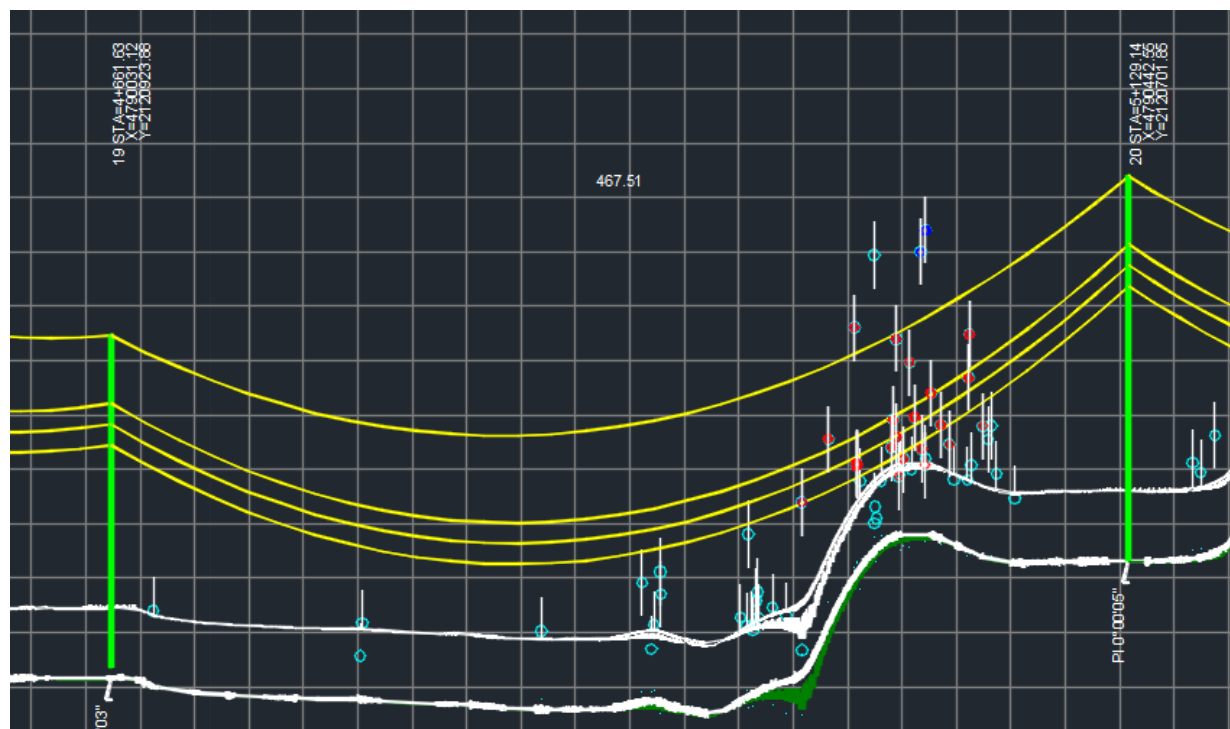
Vista en Perfil Individuos en Poda Estructuras 19 a 20
